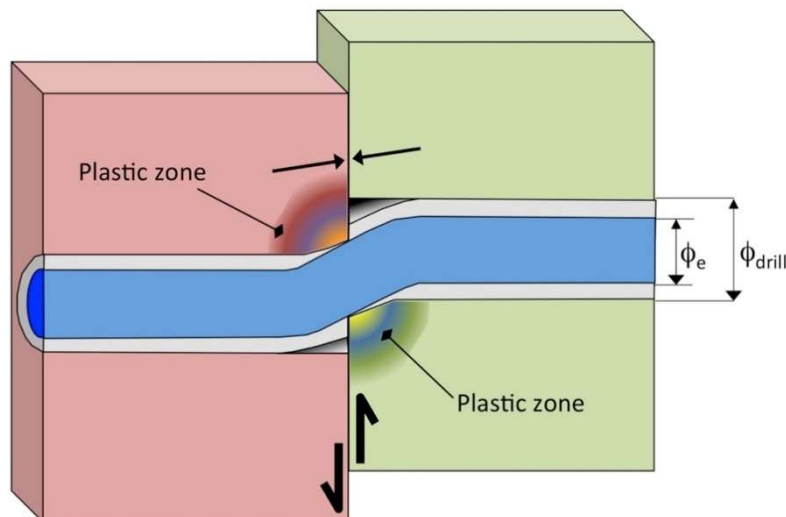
Rappresentazione in sezione dell'ancoraggio soggetto ad un'azione di taglio.
